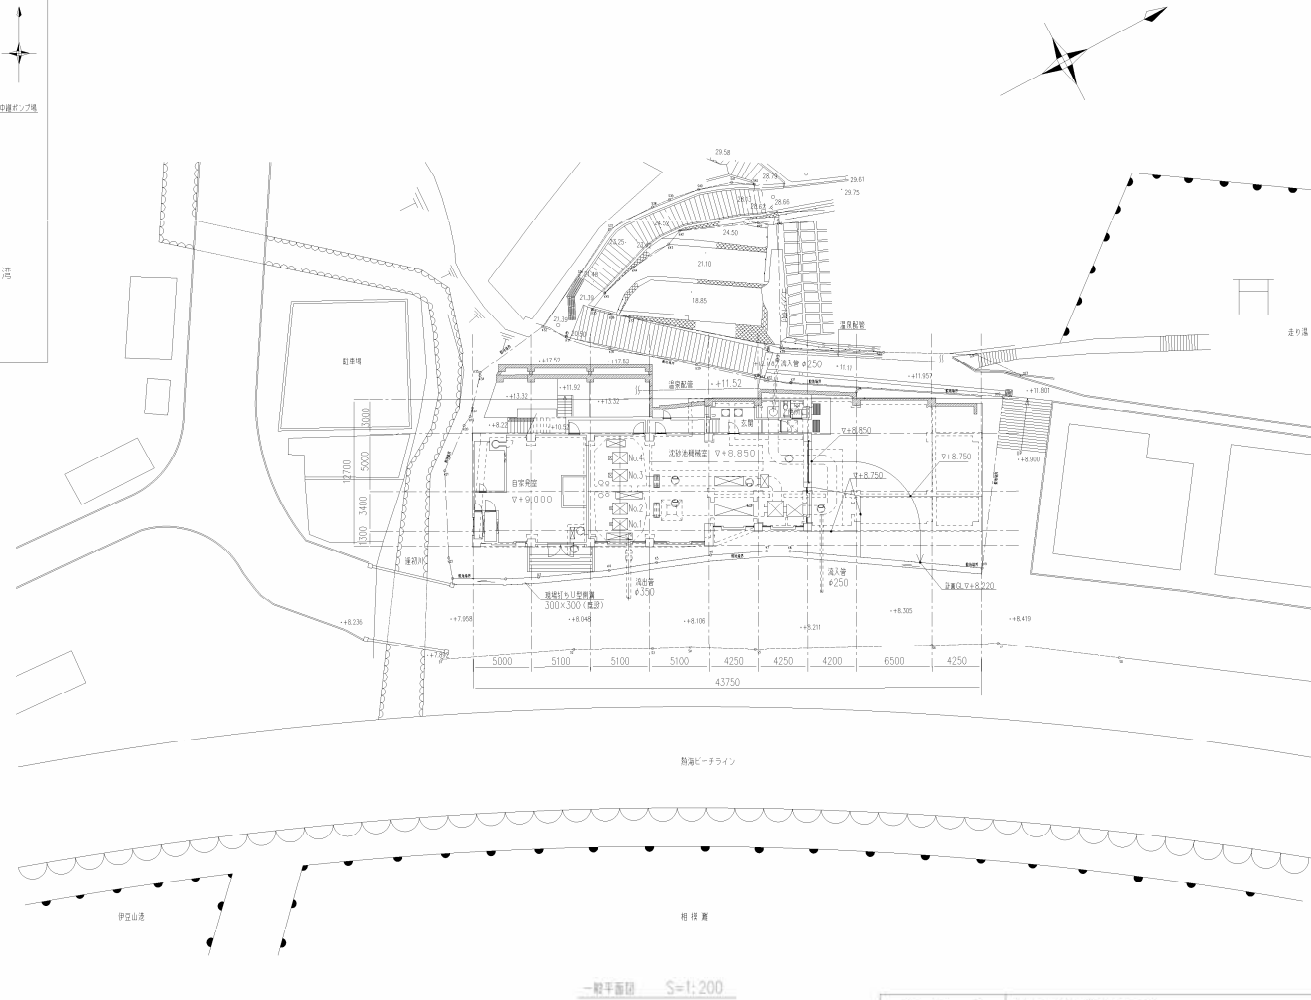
伊豆山浜中継ポンプ場 一般平面図
